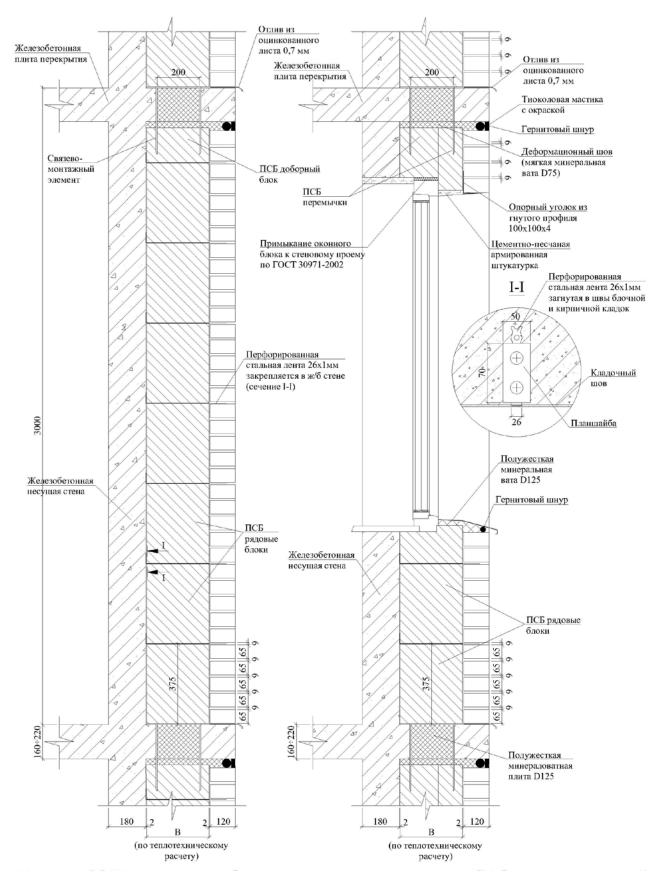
Несущая железобетонная стена, утепляемая ПСБ блоками и перемычками, с наружной кирпичной облицовкой толщиной 0,5 кирпича. Вертикальные разрезы по оконному проему и глухому простенку
